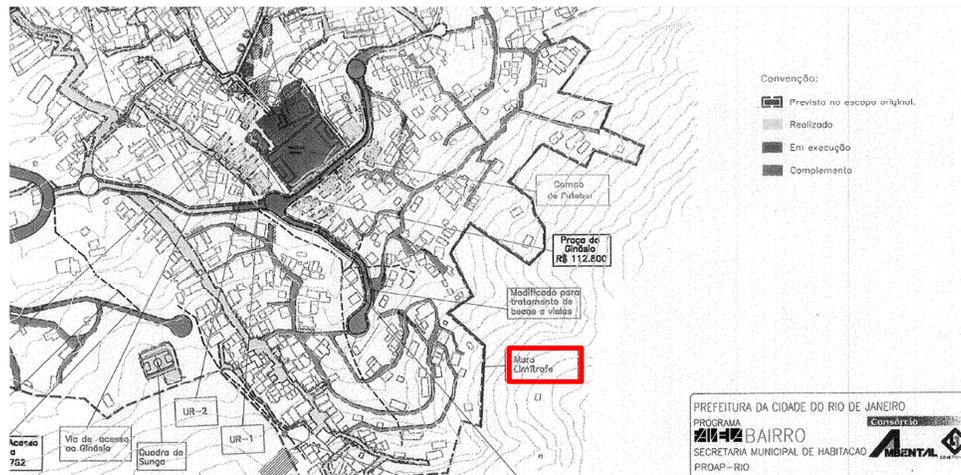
Planta Geral do Favela-Bairro, pela empresa Ambiental, que tinha o consórcio da obra, mostrando a intenção de se construir um muro limítrofe em uma parte dos limites oficiais da Favela.
